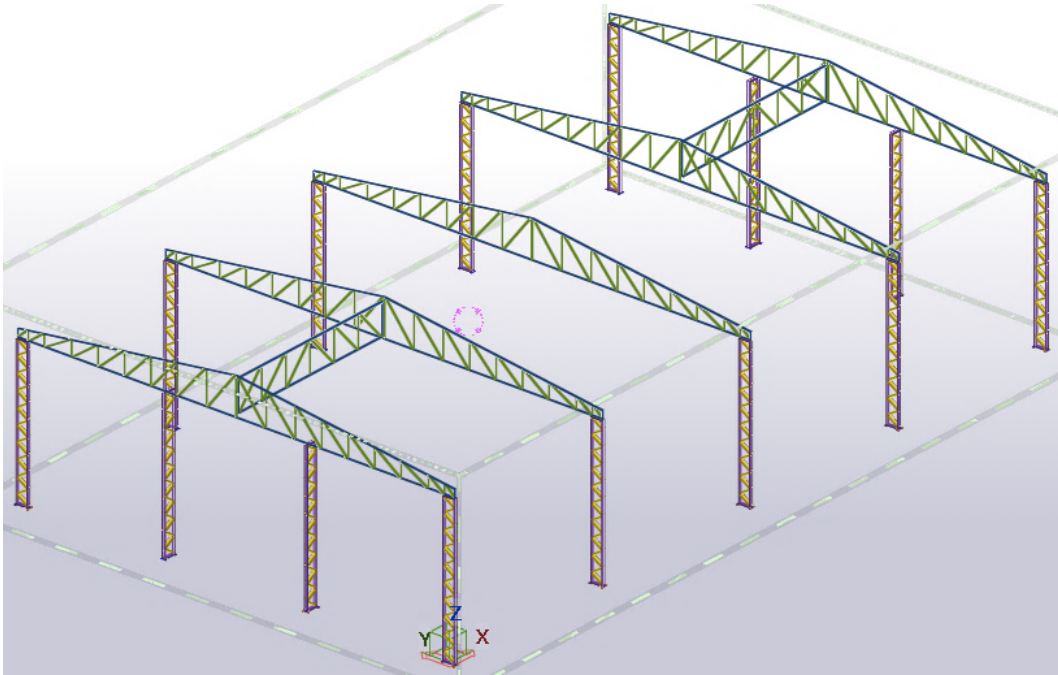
Vigas treliçadas da nave industrial no Tekla Structures 2019i
